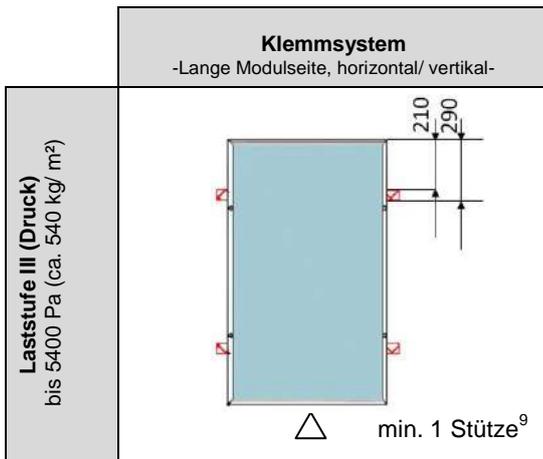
Montage-Zeichnung für das Modul P23 bei Laststufen III
